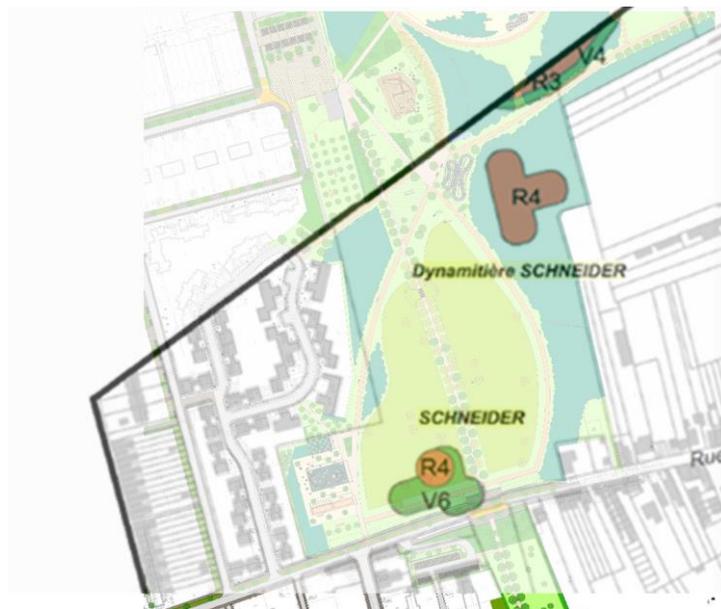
Superposition du Plan de zonage du PPRM et du plan masse
